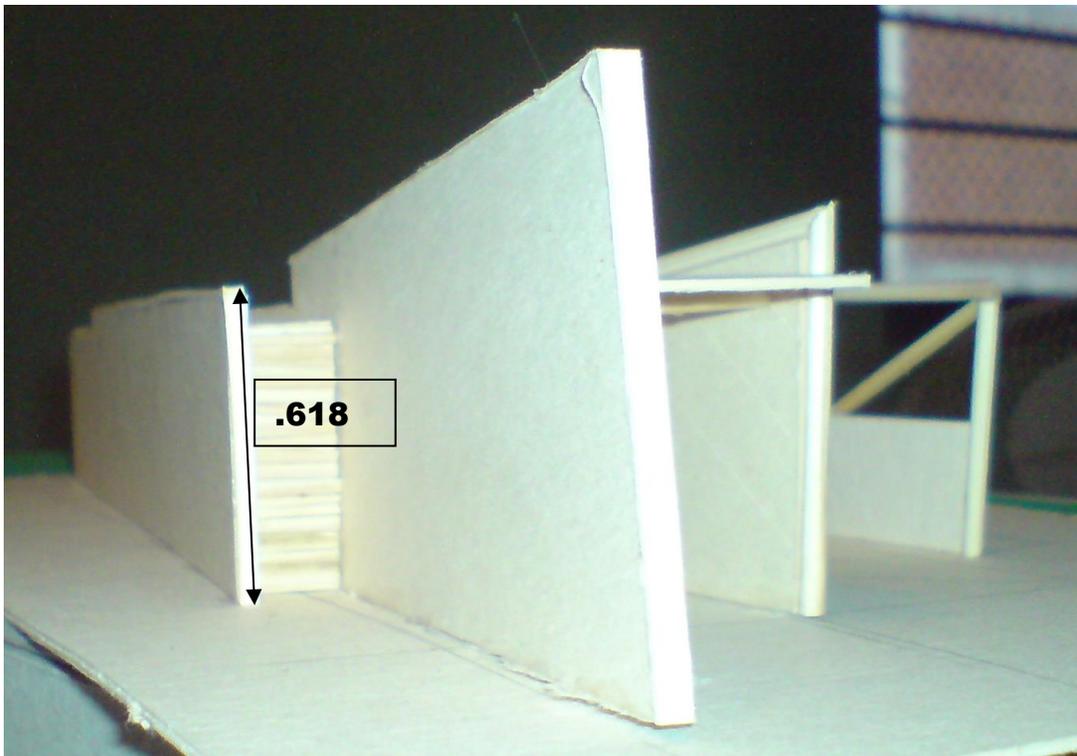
Tercer constructo, vista en perspectiva. Se toma en cuenta el trazo en altura del constructo conforme a la planta.
